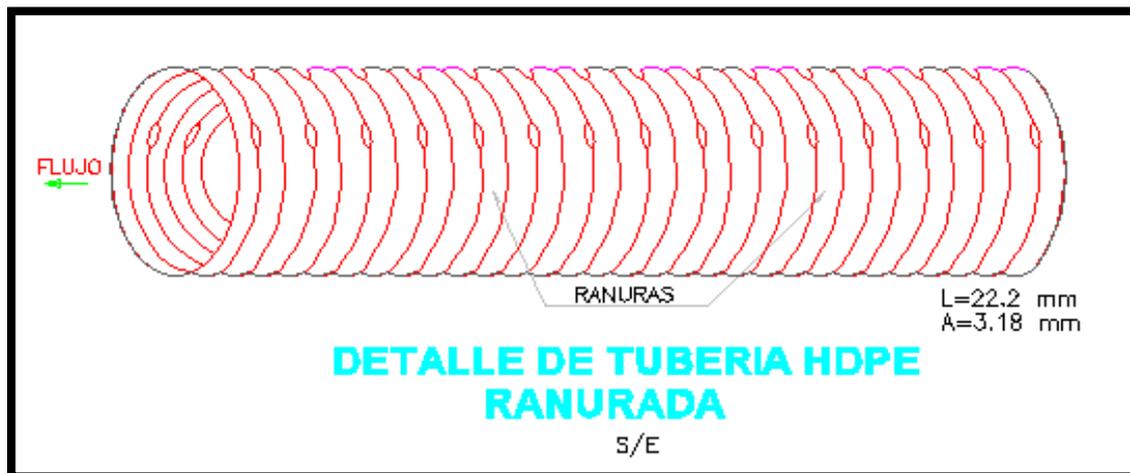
Detalle de la tubería de HDPE D=8" (200 mm)
